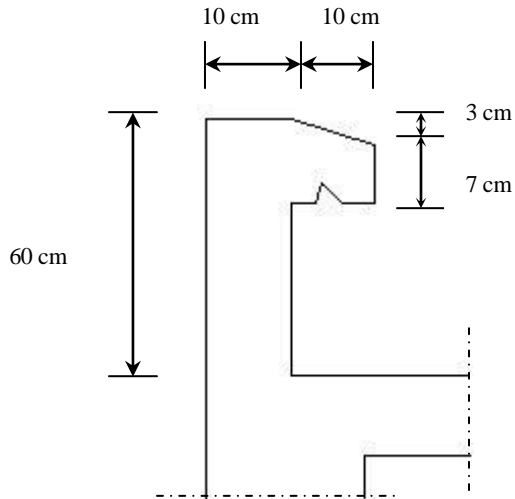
Coupe transversale de l'acrotère    Figure III.1.2 : Schéma statique de l'acrotère
